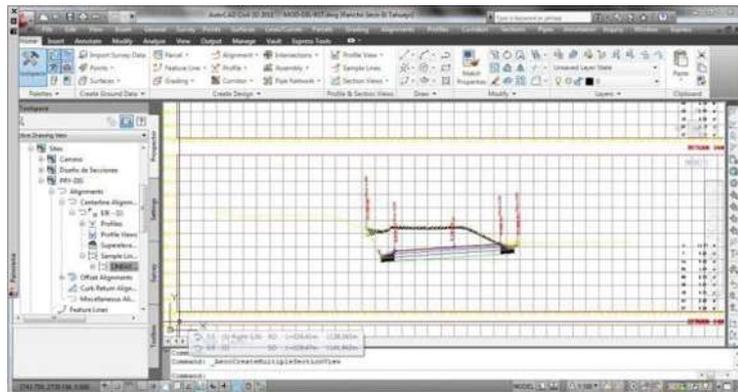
Vista de una sección constructiva con su estilo, etiquetas y tabla.
